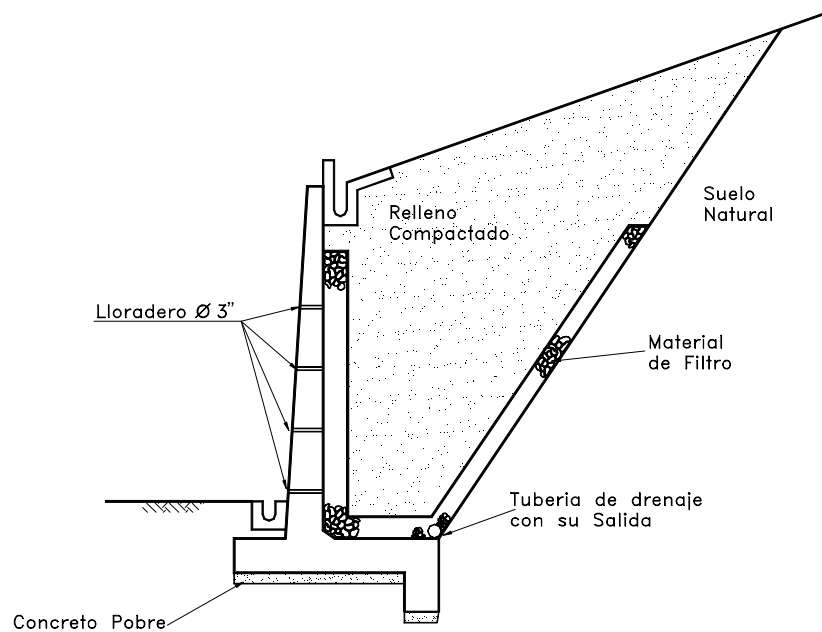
Esquema típico de un muro de concreto armado con su sistema de subdrenaje
